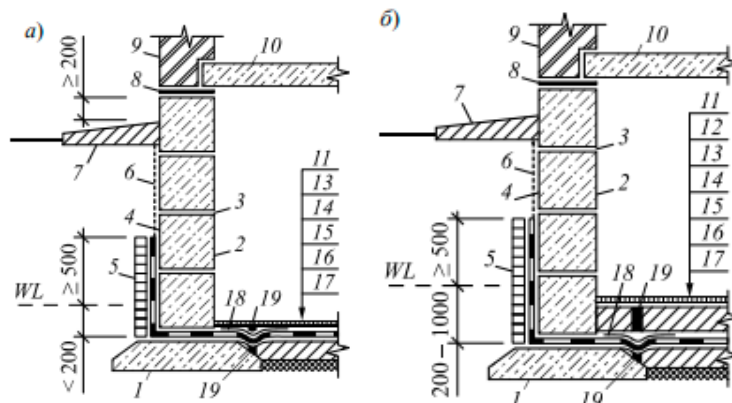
Ленточные фундаменты под стены зданий с подвалами: 1 – фундаментная плита; 2 – фундаментный блок; 3 – цементный раствор 20 мм; 4 – выравнивающая затирка цементным раствором; 5 – защитная стенка из полнотелого керамического кирпича на цементном растворе; 6 – окрасочная гидроизоляция в два слоя; 7 – отмоска; 8 – противокapиллярная гидроизоляция; 9 – стена; 10 – надподвальное перекрытие; 11 – покрытие пола подвала; 12 – железобетонная плита; 13 – защитная стяжка из цементного раствора 30 мм; 14 – рулонная гидроизоляция; 15 – выравнивающая стяжка из цементного раствора; 16 – бетонная подготовка 100 мм; 17 – жирная глина; 18 – армирующая сетка из стекловолокна; 19 – эластичный наполнитель деформационного шва
